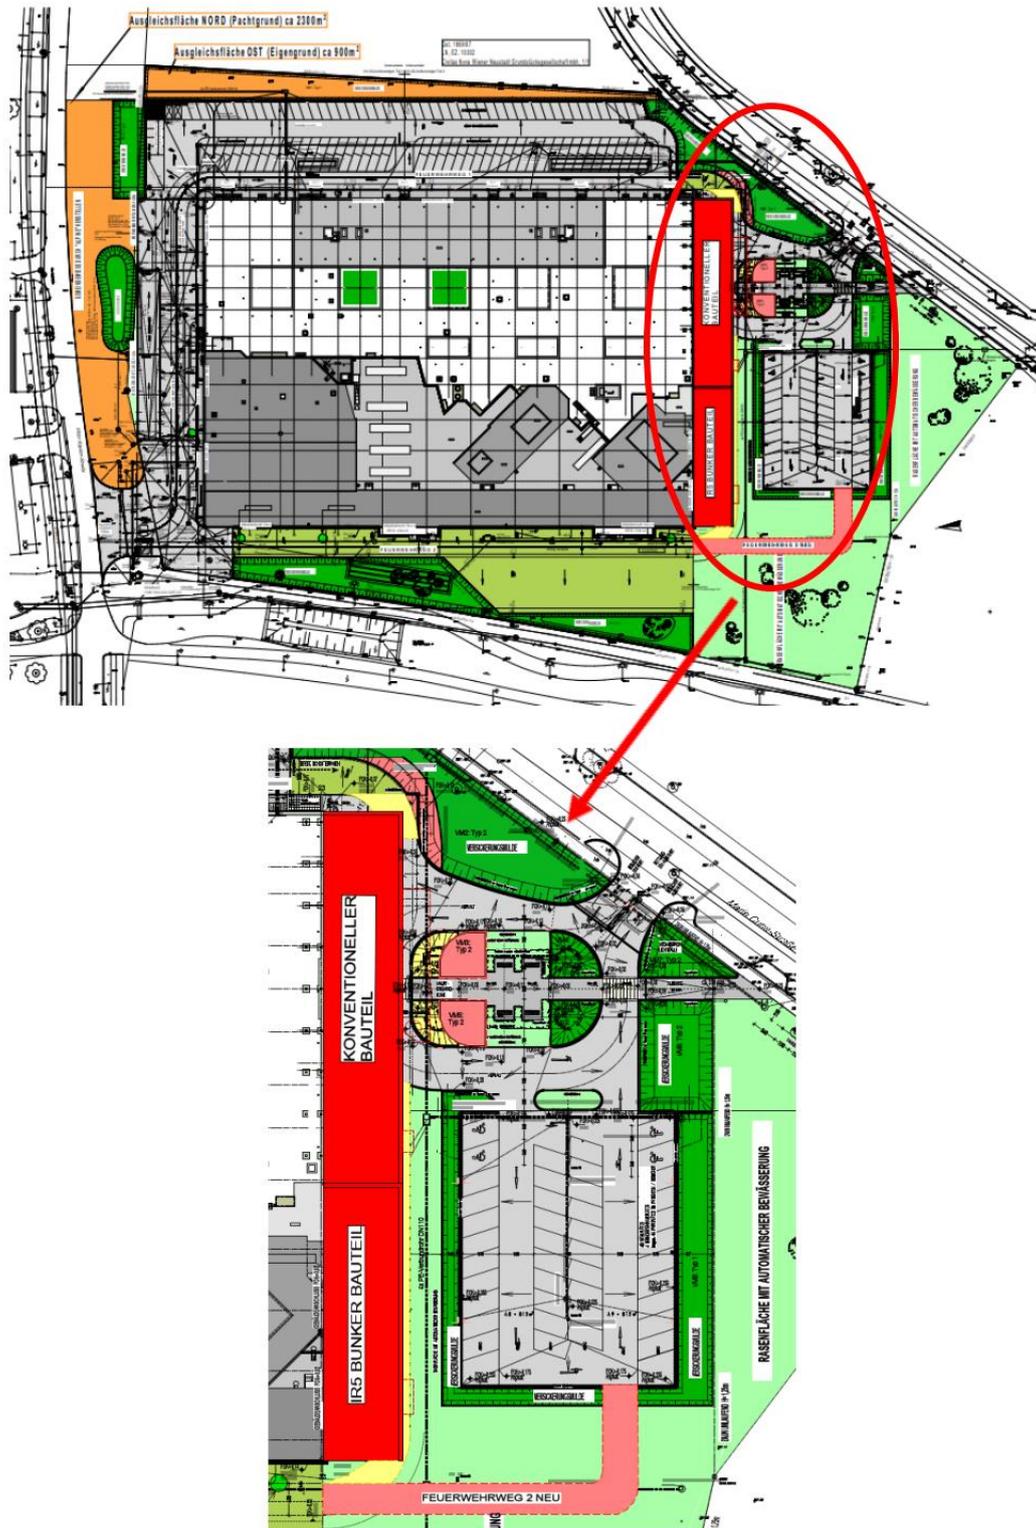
Bestehende Anlage MedAustron und Verortung des geplanten Zubaus mit den beiden Bauteilen farblich in Rot dargestellt. Details können dem Plan „B.03-01 P01 1.0 A Grundriss Erdgeschoss“ entnommen werden.
